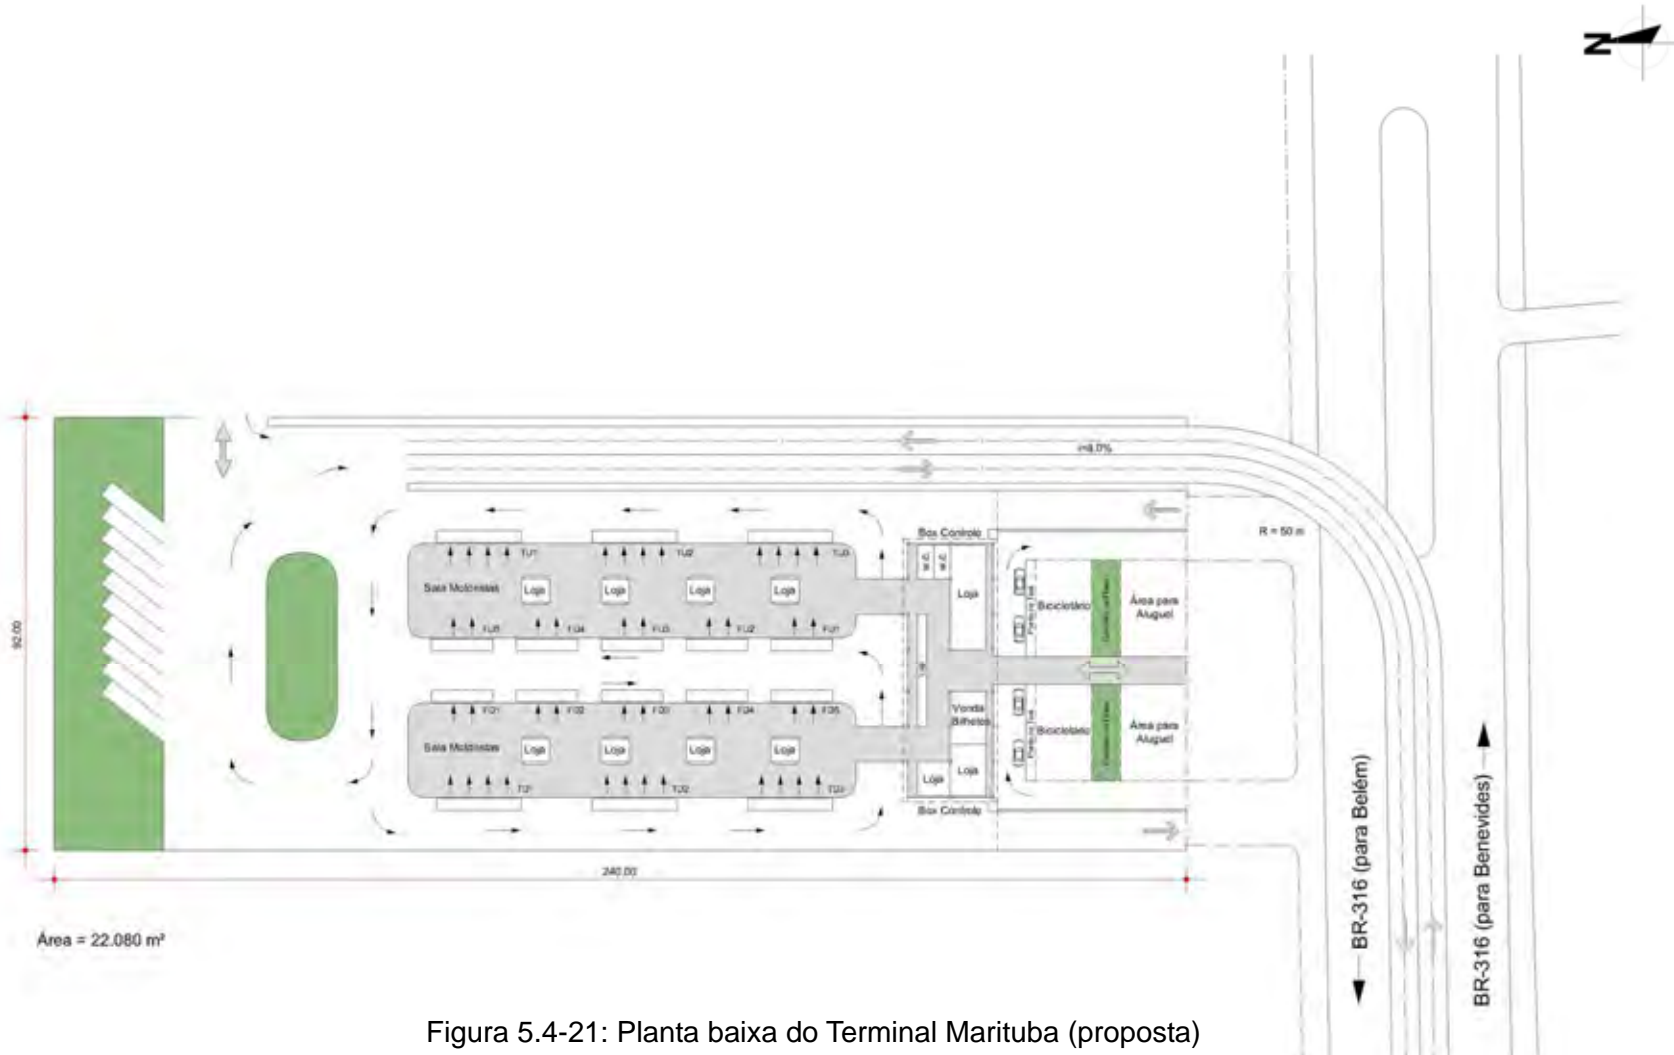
Planta baixa do Terminal Marituba (proposta)
